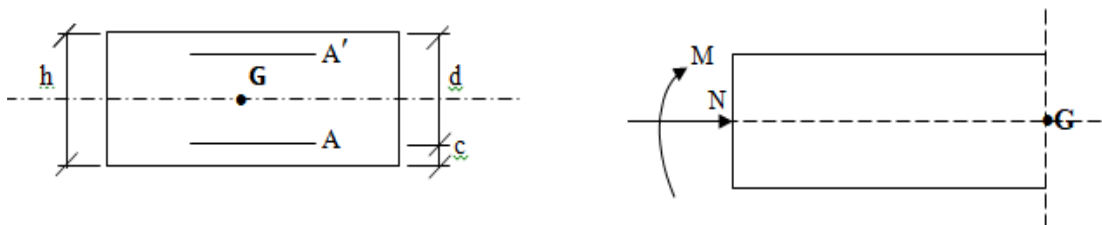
Dimension de la section à ferrailer d’acrotère
